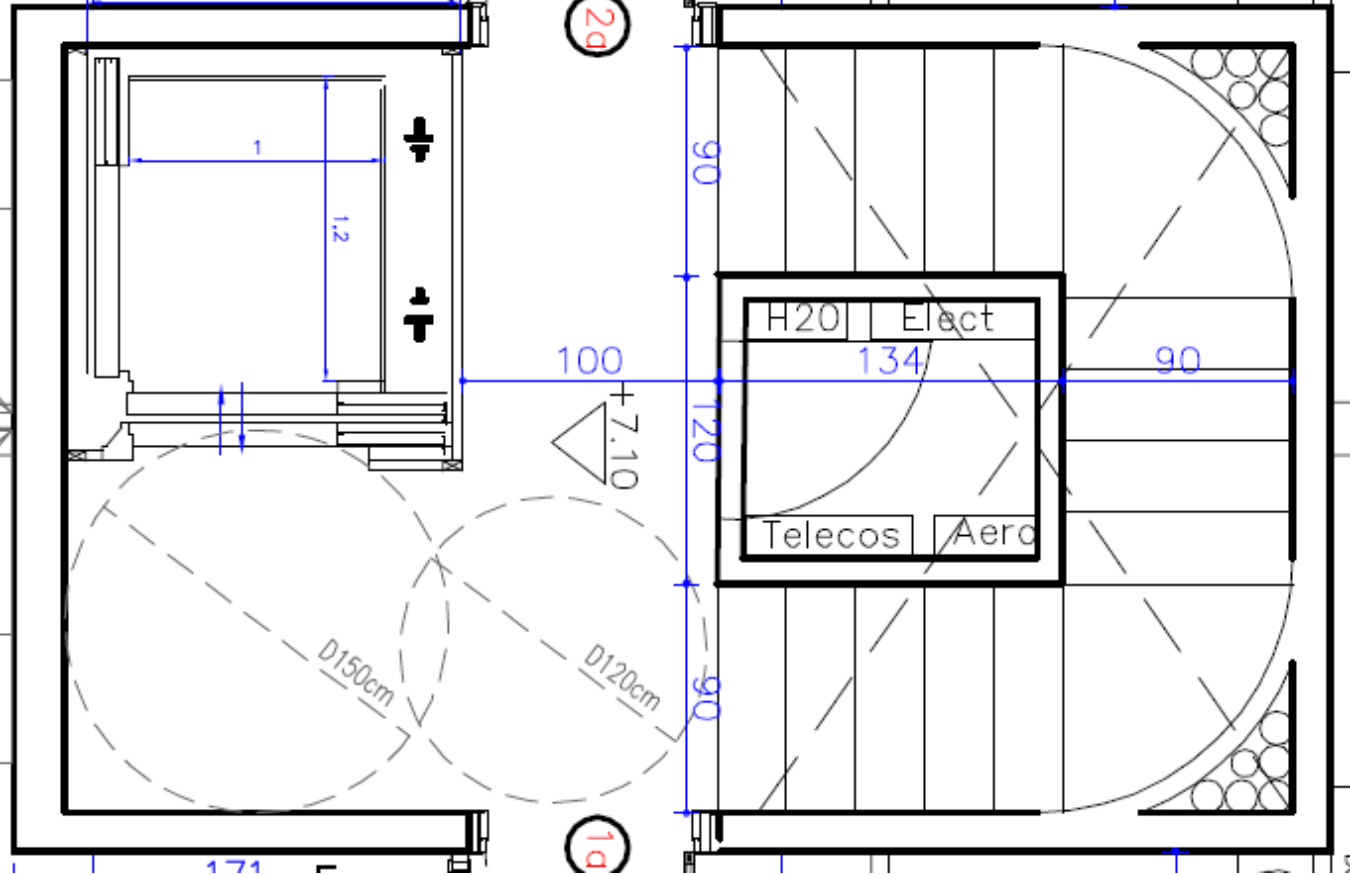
Detall els replans de plantes pis i escala(Annex 3)
